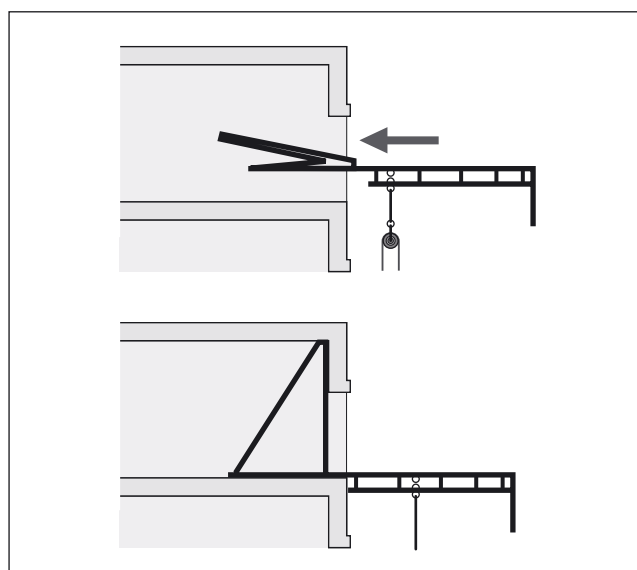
Progetto e posa in opera delle passerelle di servizio.
